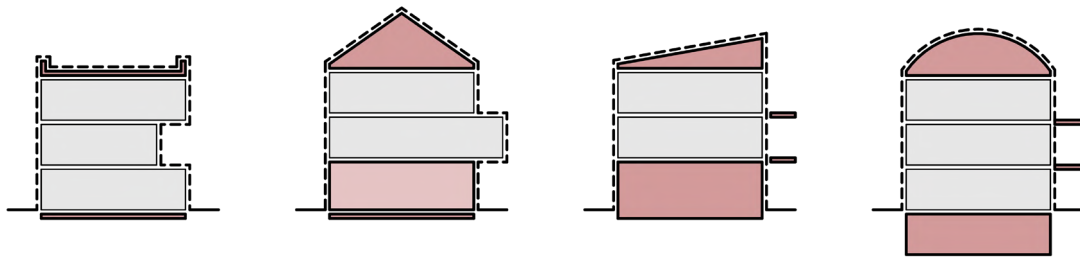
Möglichkeit zur Gestaltung durch offene Systemlösungen für Gründung, Dachkonstruktion und Außenanlagen.
